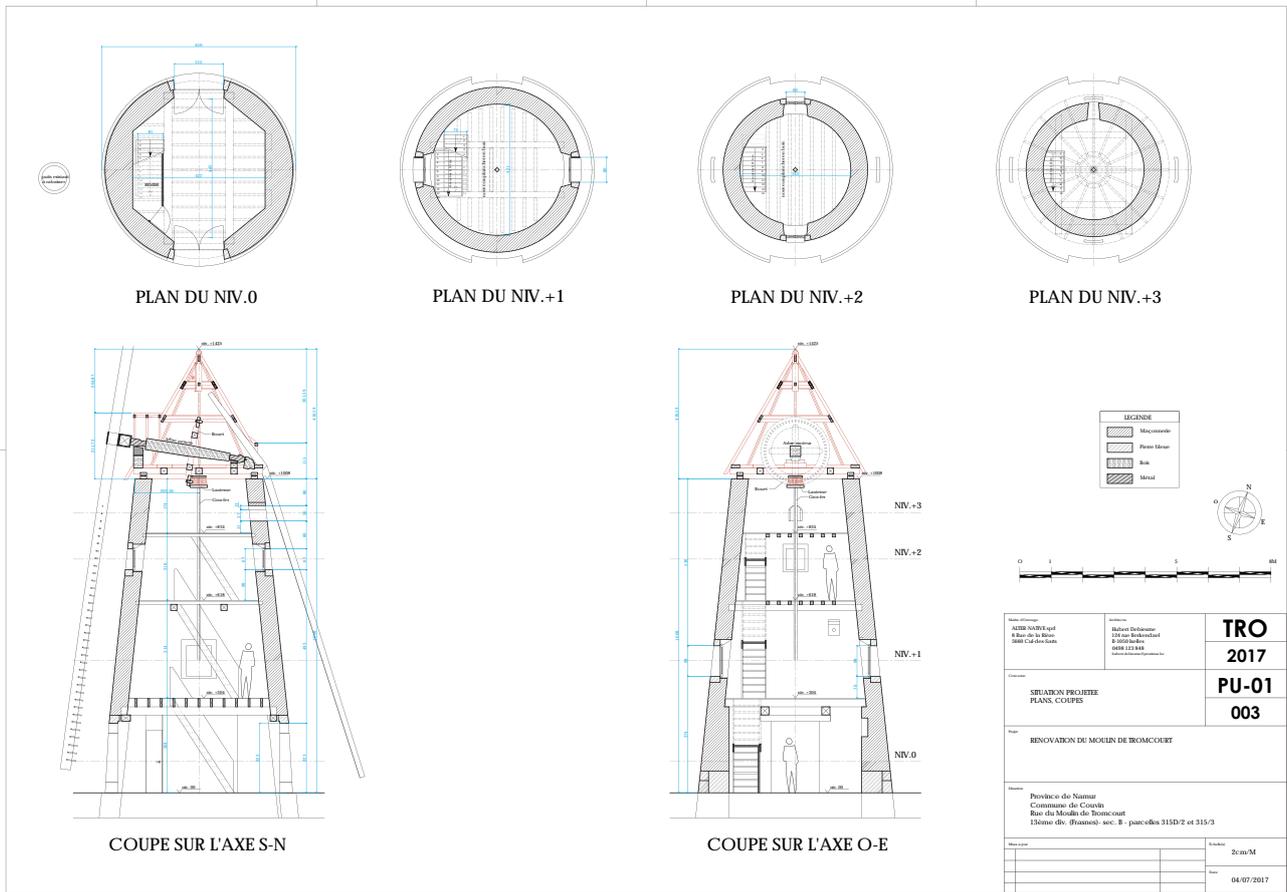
Projet de restauration du moulin de Tromcourt. Situation projetée : plans et coupes. © Architecte H. Debiesme.
